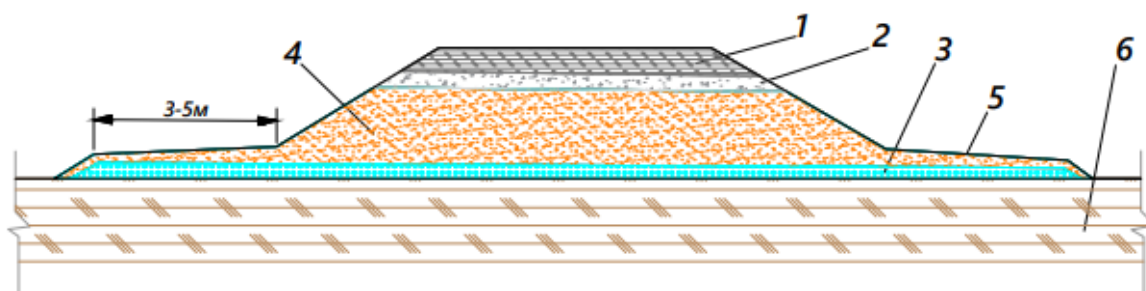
Схема устройства теплоизоляционного слоя на пучинистом модифицированном грунте (глина, суглинок): 1 – дорожная одежда; 2 – подстилающий слой; 3 – рулонная тепло- гидроизоляция на основе рулонного пенополиэтилена; 4 – насыпь; 5 – защитная берма; 6 – пучинистый грунт основания.
